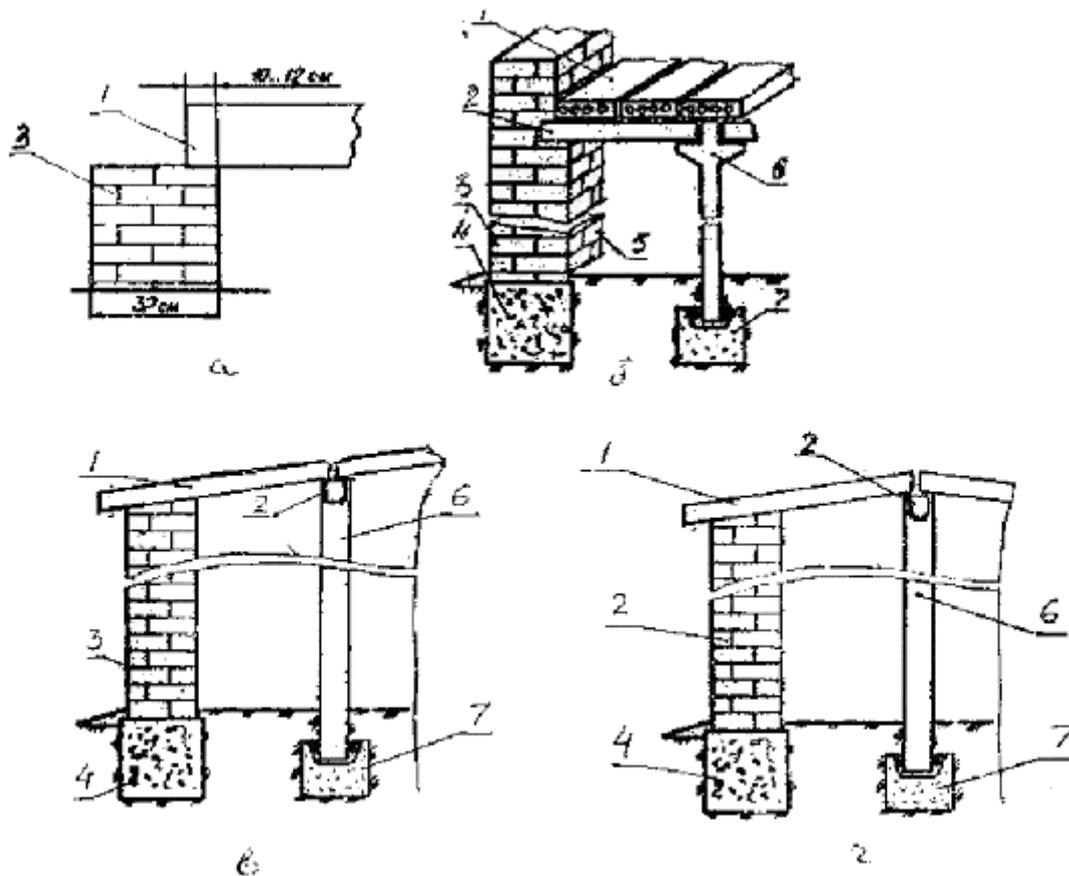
Схемы устройства перекрытий : а - плоское с укладкой плит на несущие стены ; б – плоское с укладкой плит на колонны с балки ; в – односкатное с укладкой плит на колонны ; г – Двухскатное с укладкой плит на колонны и балки : 1 – плита перекрытия ; 2- балки ; 3- стена ; 4- фундамент ; 5- пилеастра ; 6- колонны ; 7- стакан (подколонник)
